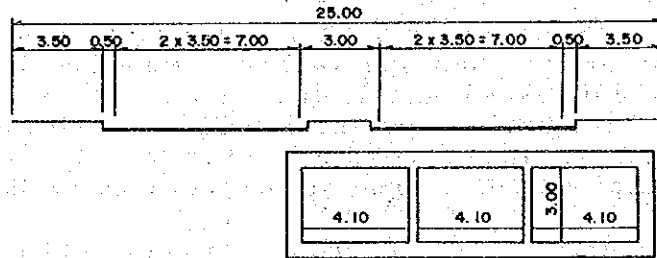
PROPUESTA DE LA SECCION TRANSVERSAL EXISTENTE
